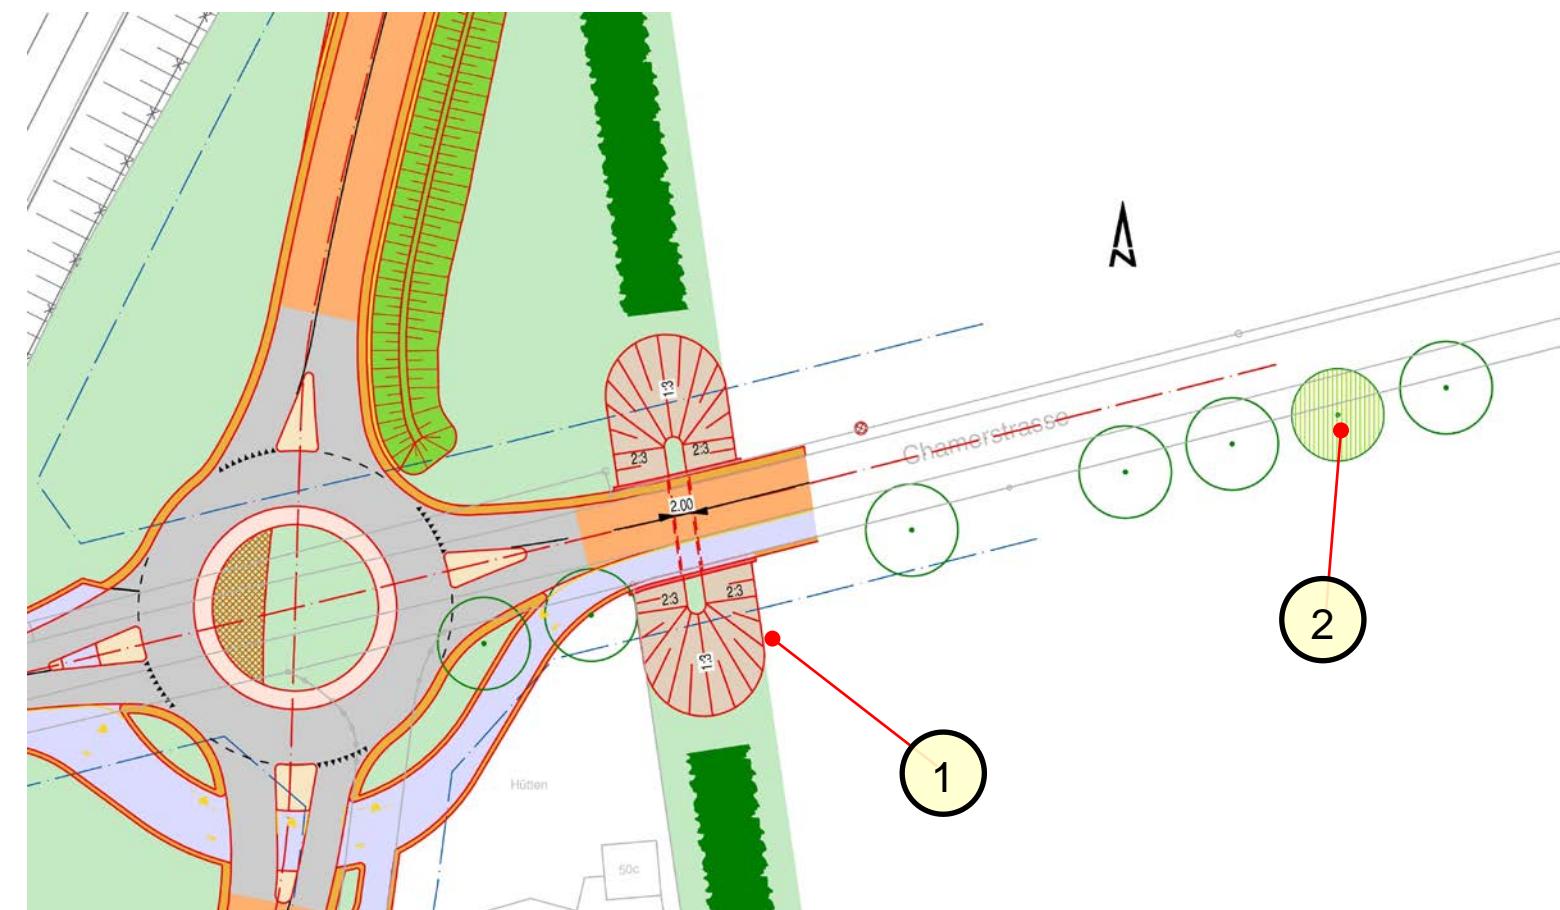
neuer Kleintierdurchlass Schlatt, Ersatz wegfallender Baum
